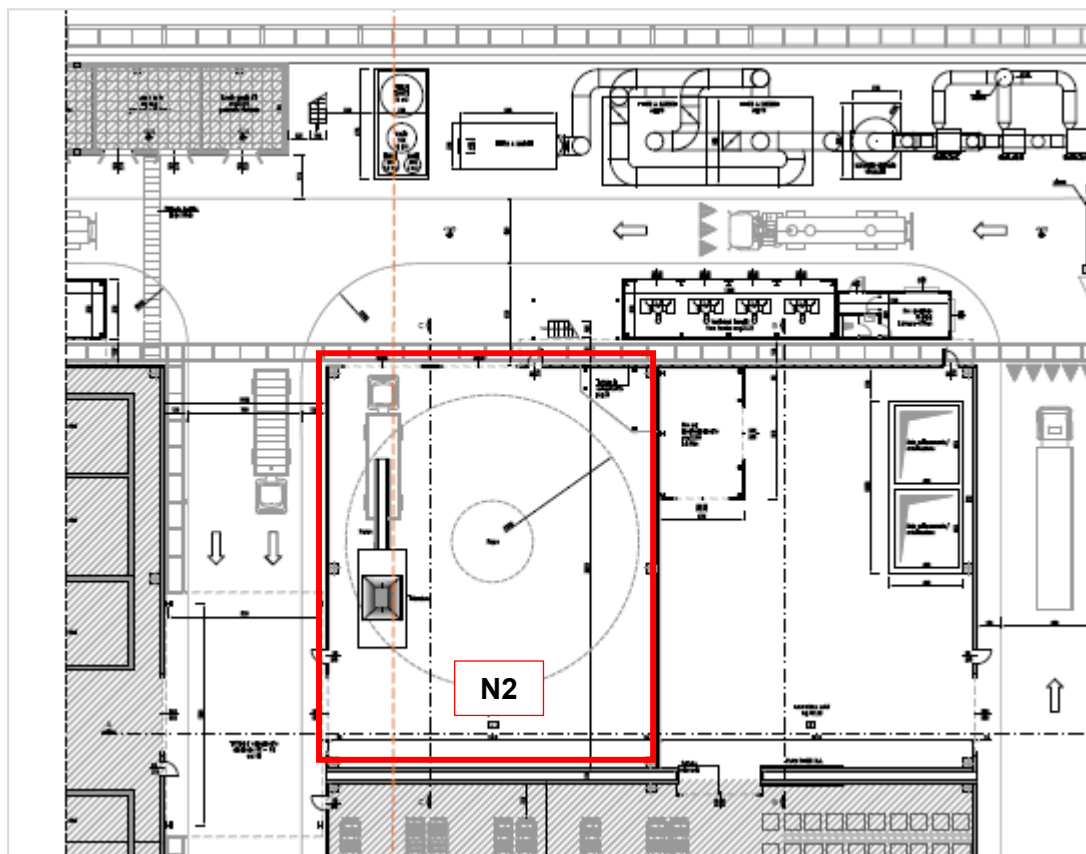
Dettaglio localizzazione Sezione N2 (stralcio elaborato CO 05 RA VA 01 D1 PL 58.00 - N1-N2 PIANTE)
